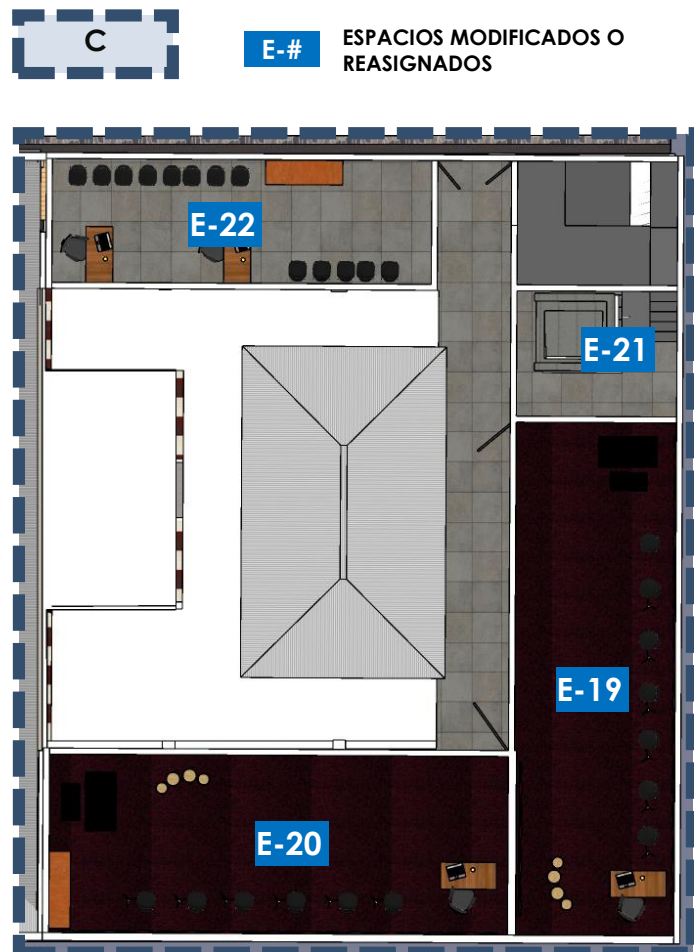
Propuesta de planta arquitectónica segundo nivel.
